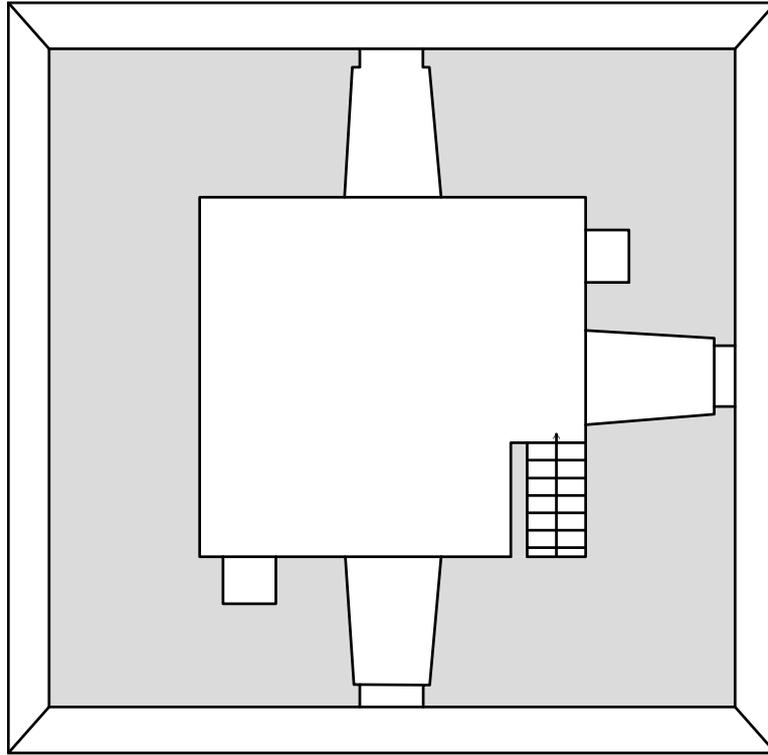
Torre San Giovanni, pianta del piano primo (rielaborazione grafica).
